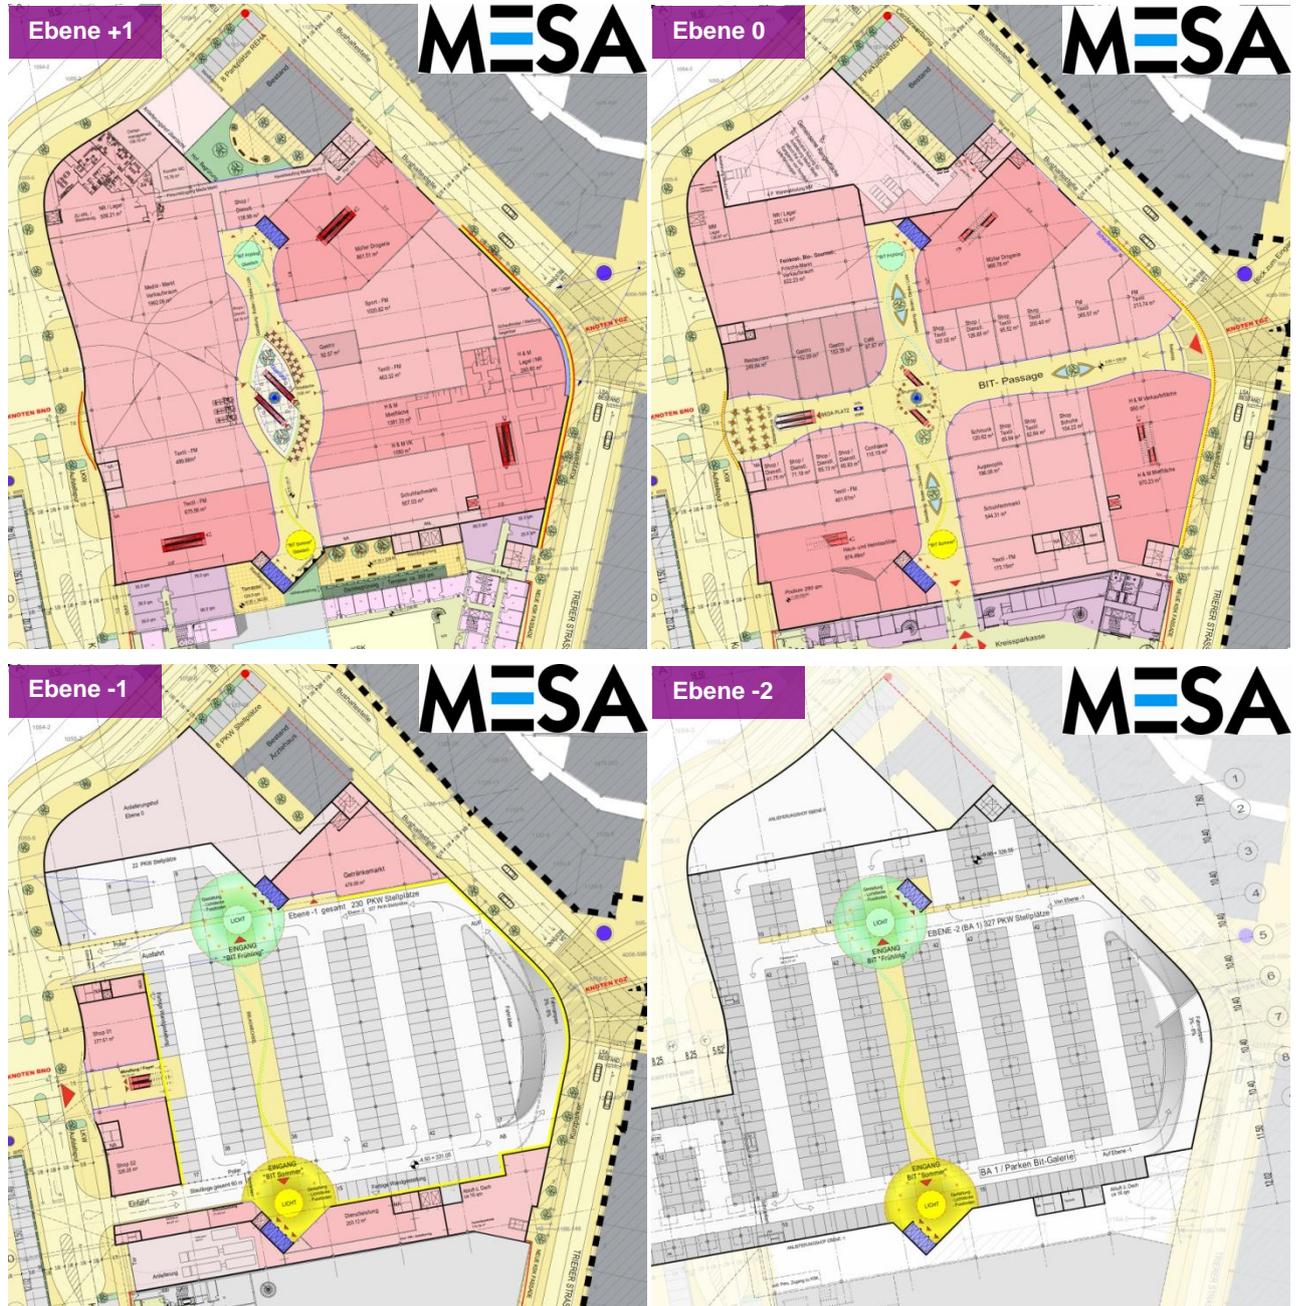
Entwurf zur Bit-Galerie, kleine Variante mit Erhalt Karenweg 6 – unverbindliche Illustration
